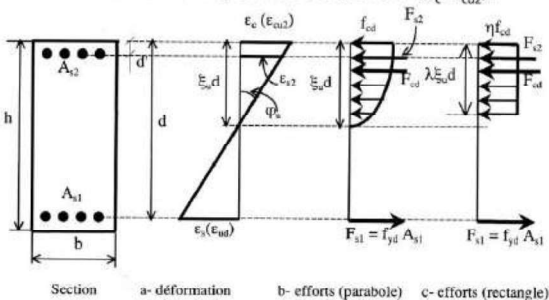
Comportement de la section d'une poutre fléchie en béton armé à l'ELU
